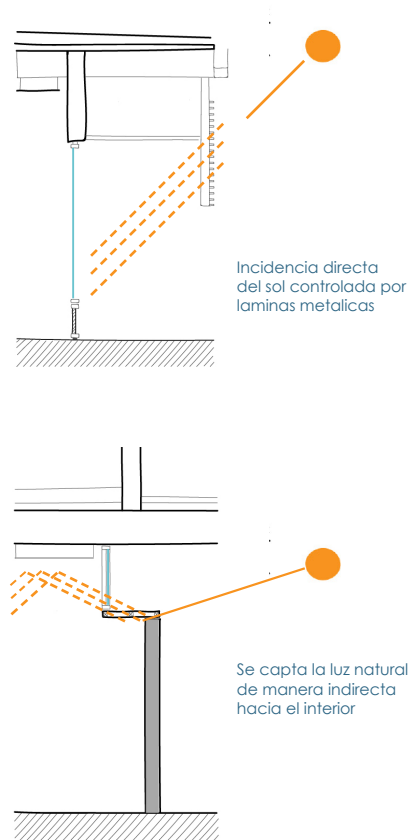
Esquema funcional del sistema constructivo en fachadas. Fuente: Elaboración propia
